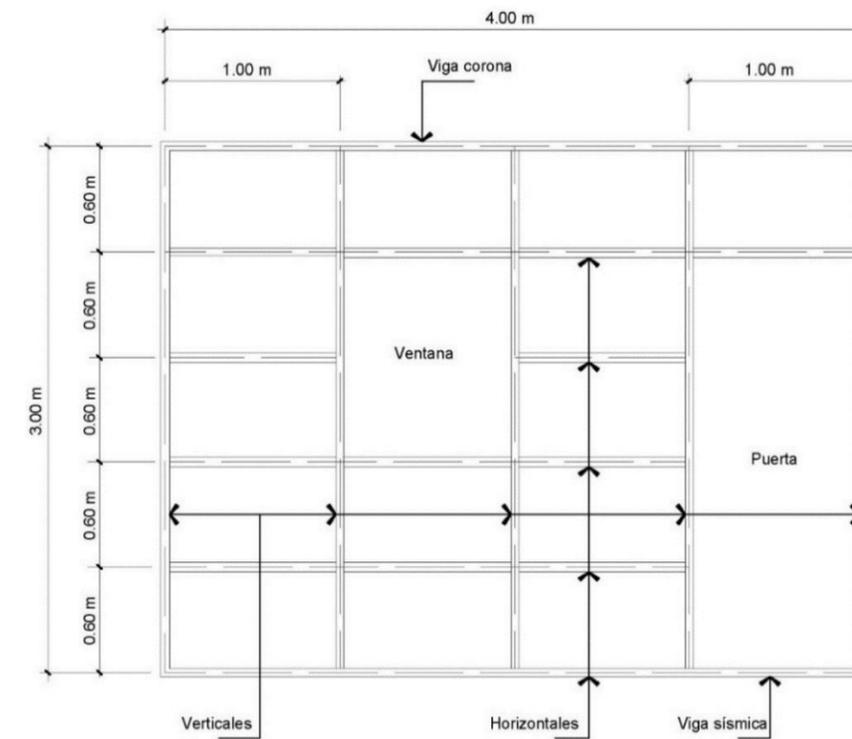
Tablero para cerramiento liviano. Fuente: equipo de trabajo
